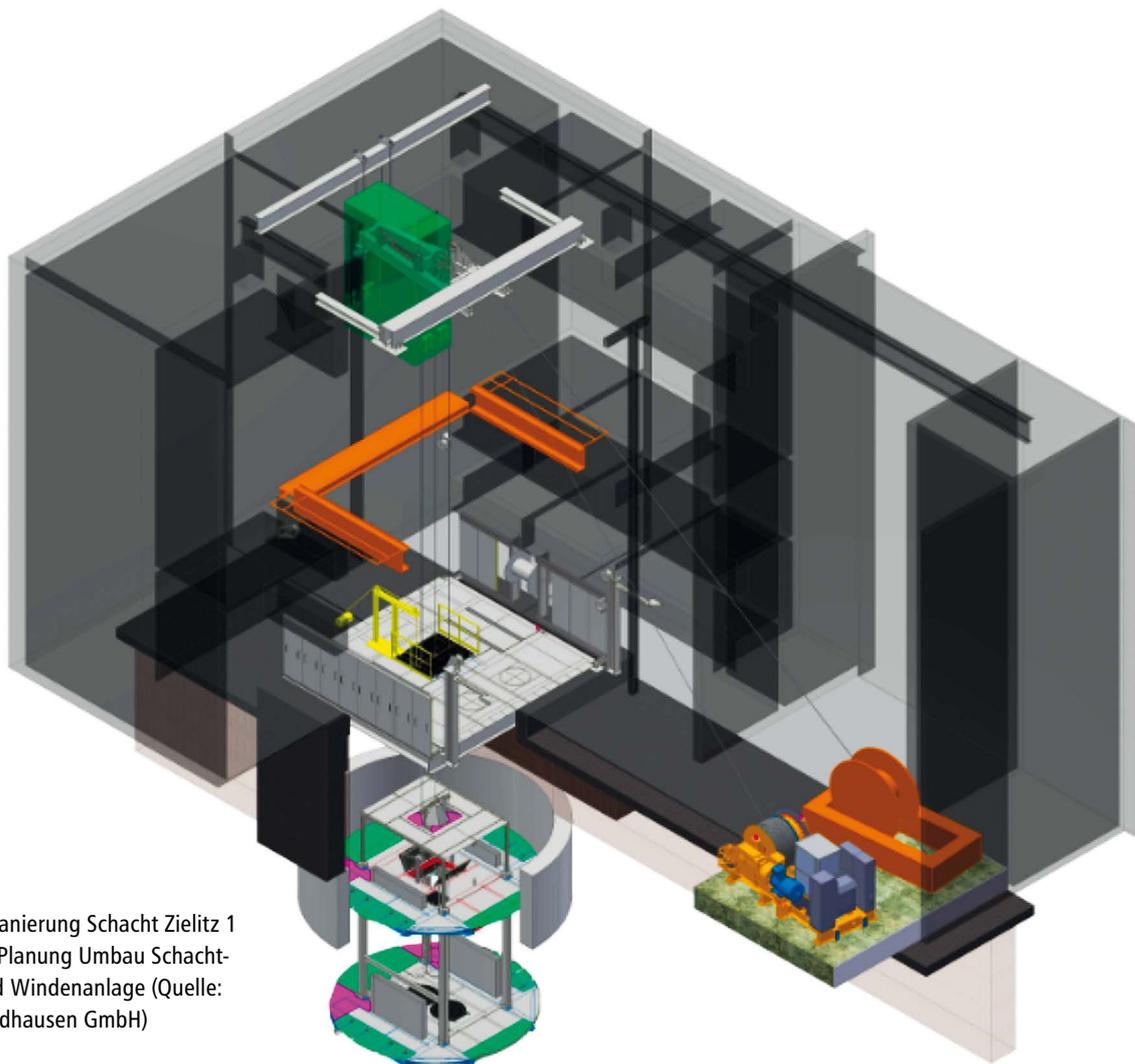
Sanierung Schacht Zielitz 1 (540–565 m) – Planung Umbau Schachtkopf, Bühne und Windenanlage (Quelle: Schachtbau Nordhausen GmbH)
